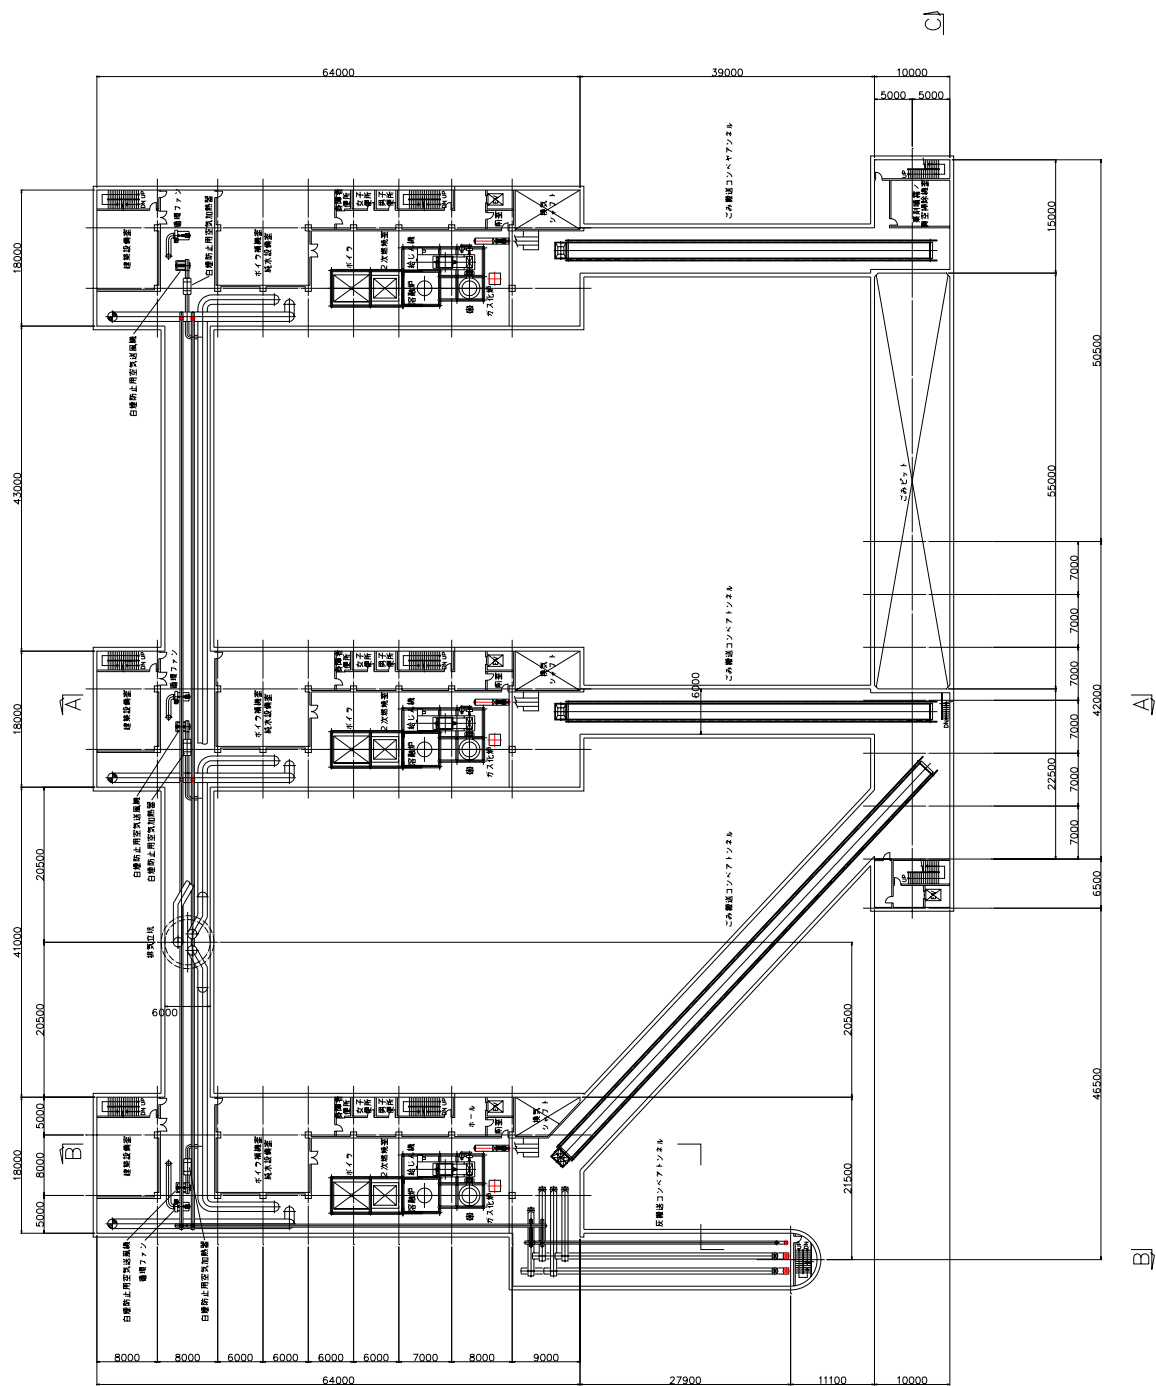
横型 (横坑式) ガス化溶融機械システム B7FL 機器配置平面図 (1/1,000)
